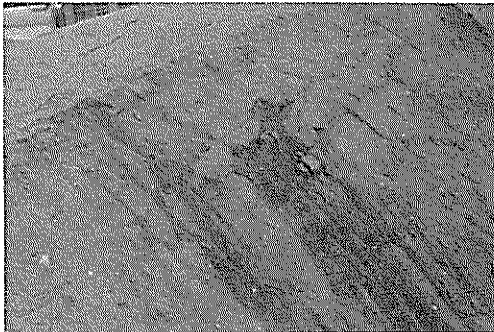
・b 起振力 10 ton で加振後の状態 (Test 10)
